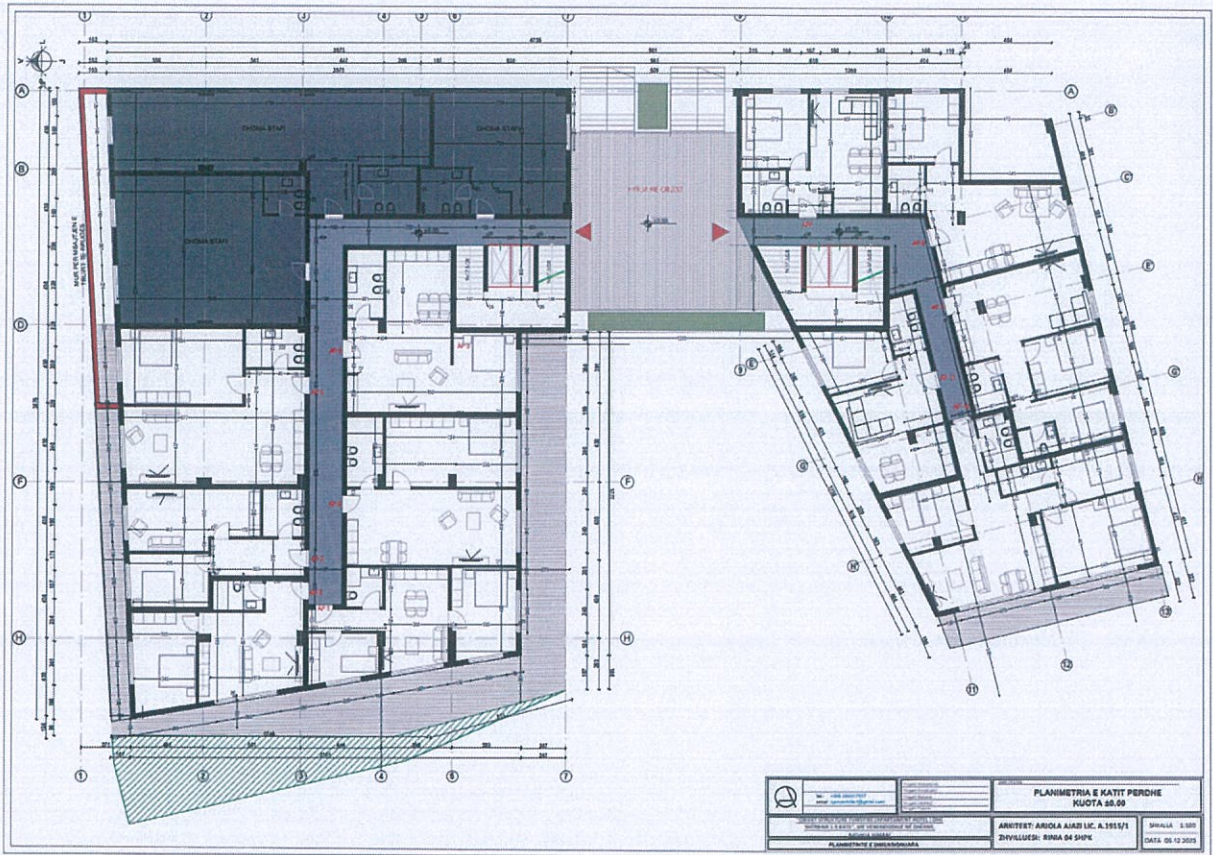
Planimetria e katit përdhe (kuota e re 0.00)
